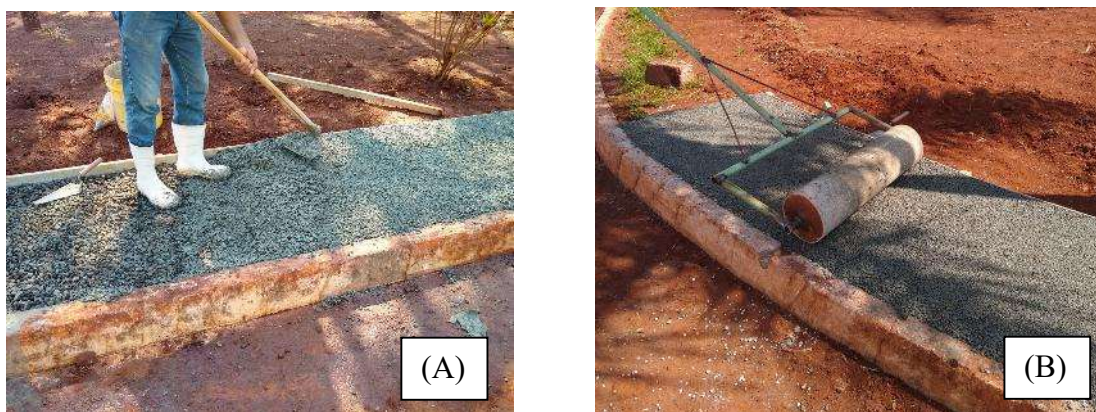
Processo de construção da praça: (a) aplicação do concreto poroso; (b) utilização do rolo compactador
